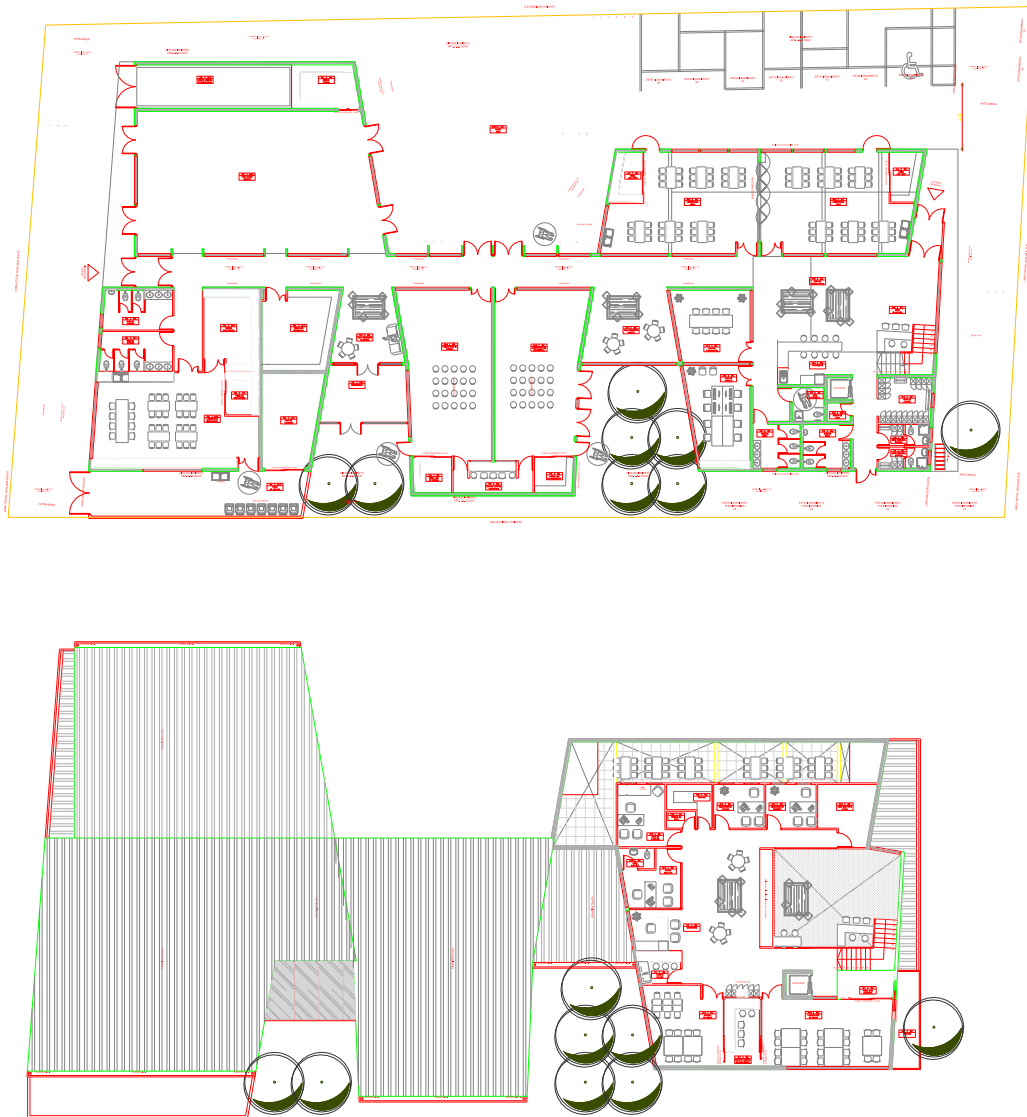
Planta de arquitectura del edificio del Centro Cultural. Primer piso (arriba) y segundo piso (abajo)
